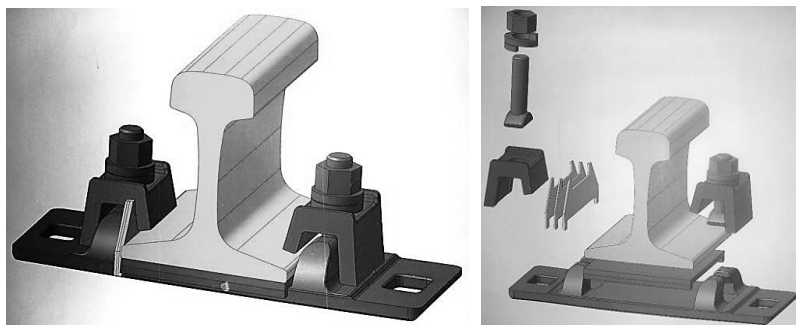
Конструкция промежуточного скрепления СКД65-Б
